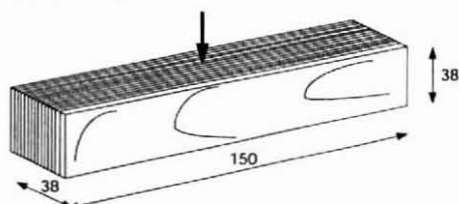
Probeta para el ensayo de compresión perpendicular (medidas en mm)
